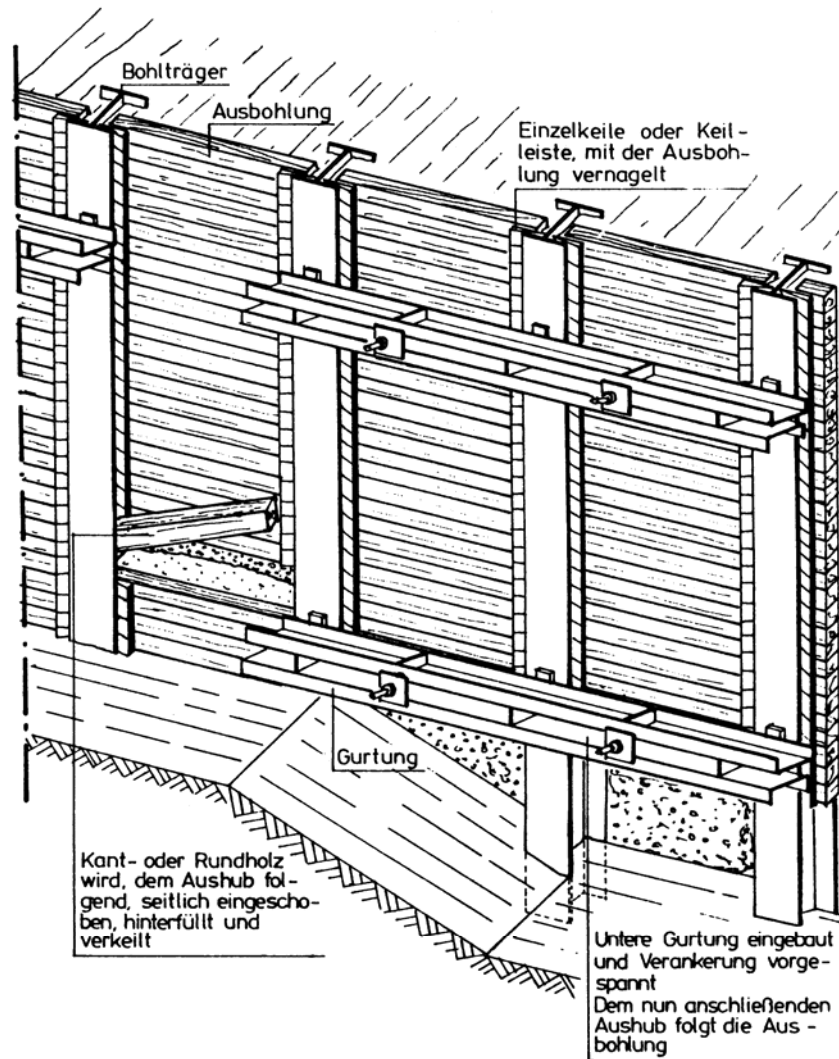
Trägerbohlwand mit waagerechter Holzausfachung [5]
